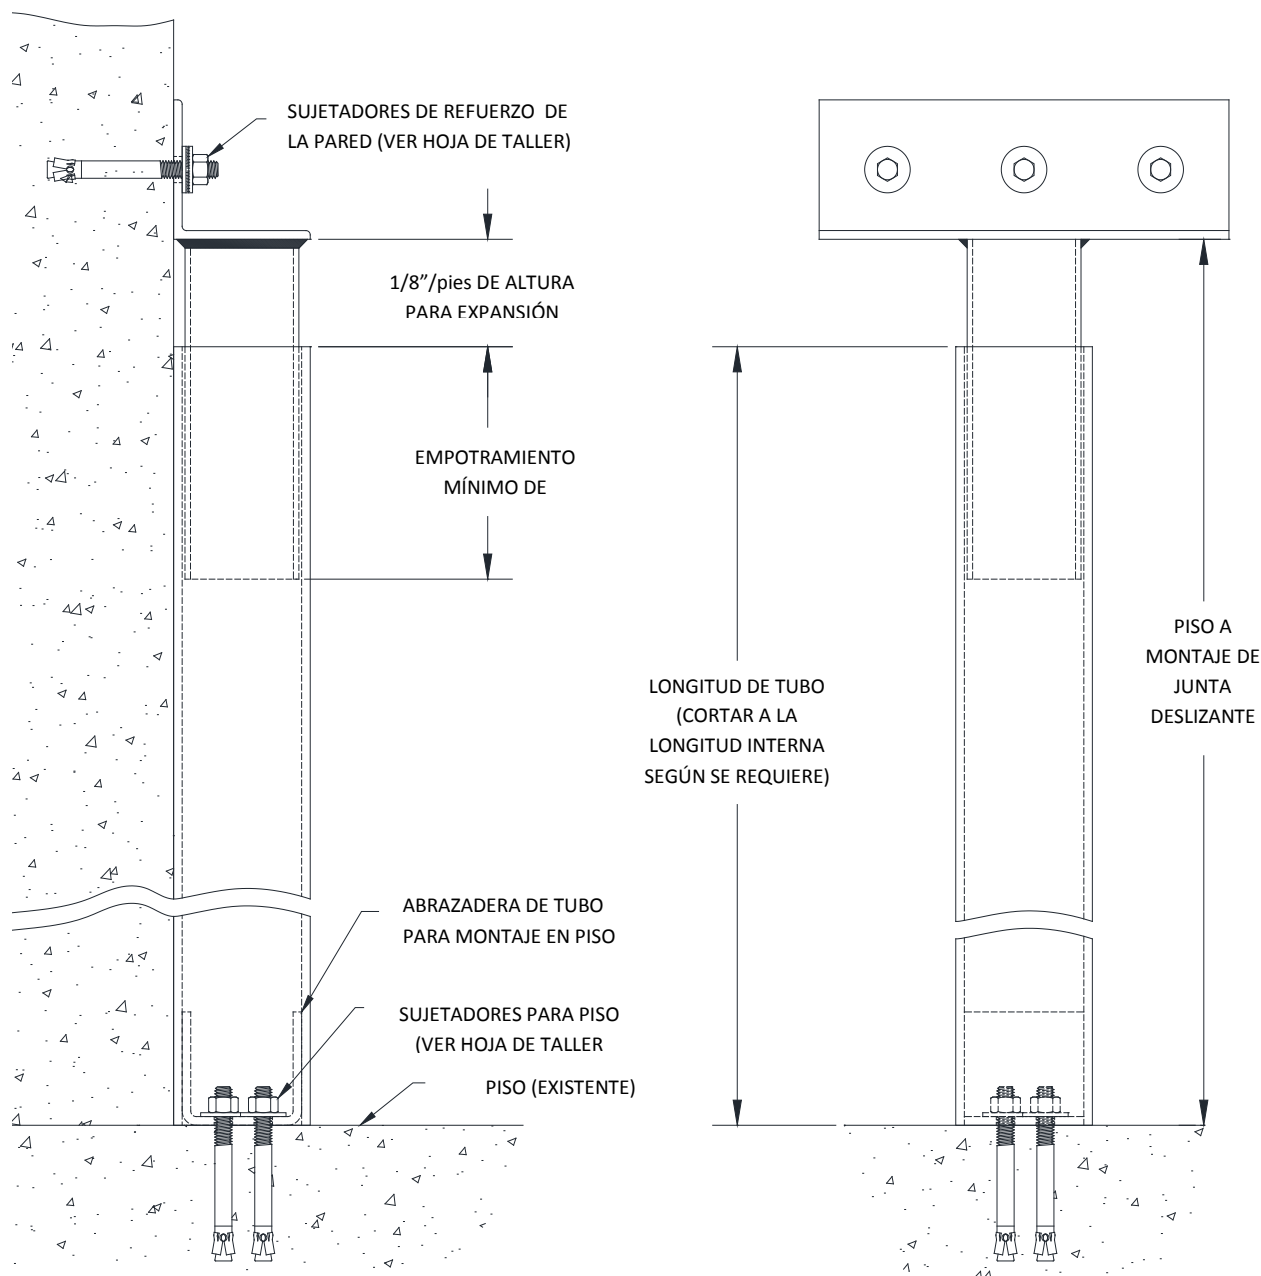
Junta Deslizante – Piso a Pared con Ensamblaje de Montaje de Ángulo
